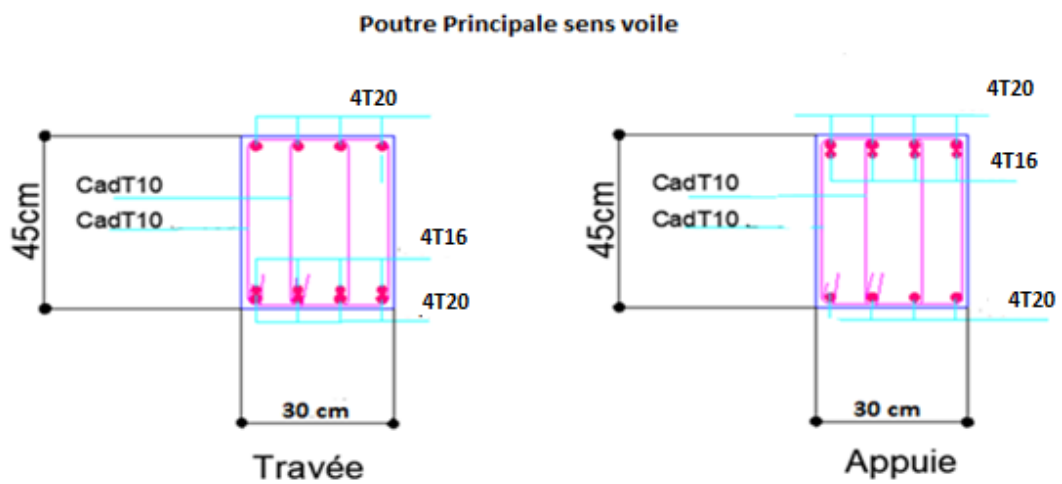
Schéma de ferrailage De la poutre principale sans voile
